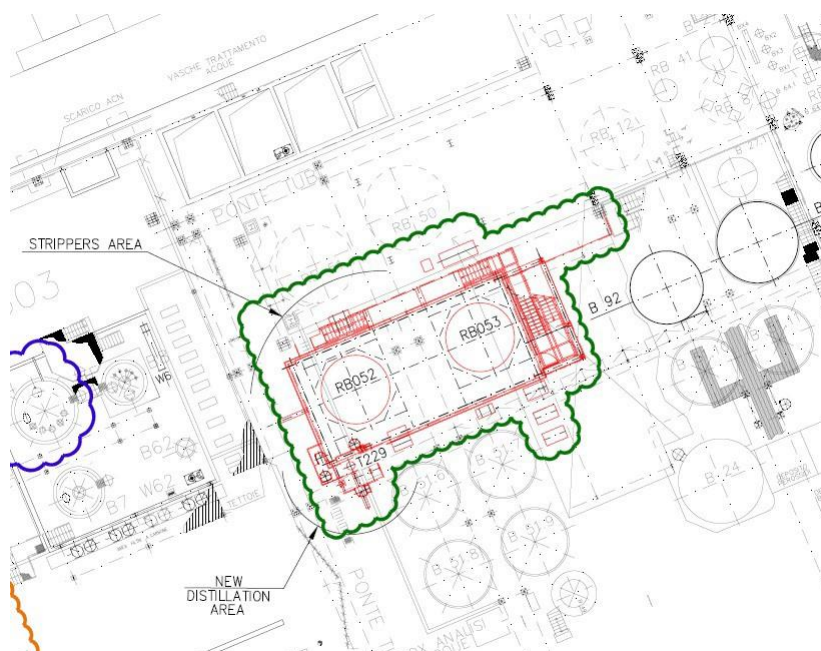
Planimetria nuovo edificio di destinazione dei due nuovi strippers RB052 e RB053
